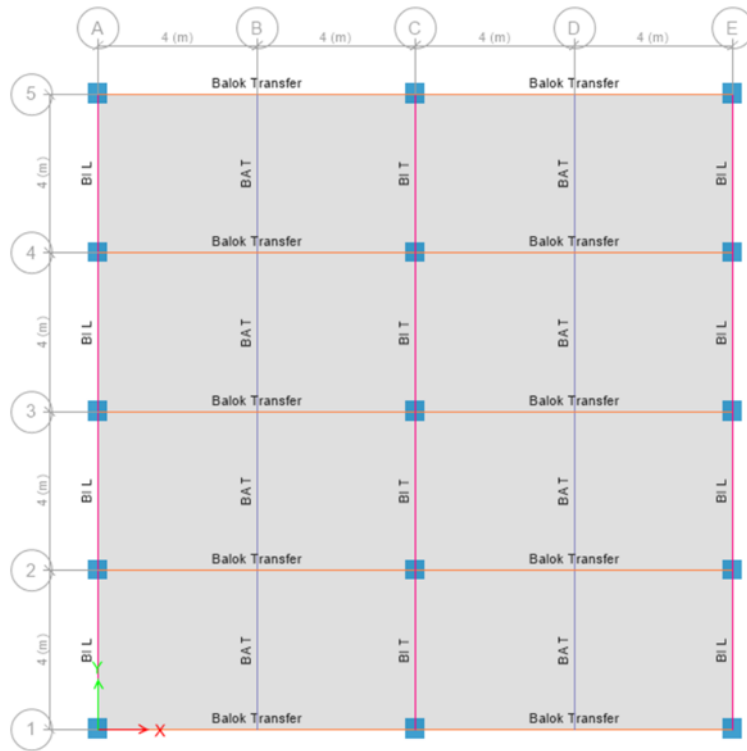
1 Model 1 dengan Balok Transfer di Lantai 1 (Potongan 2-2)
